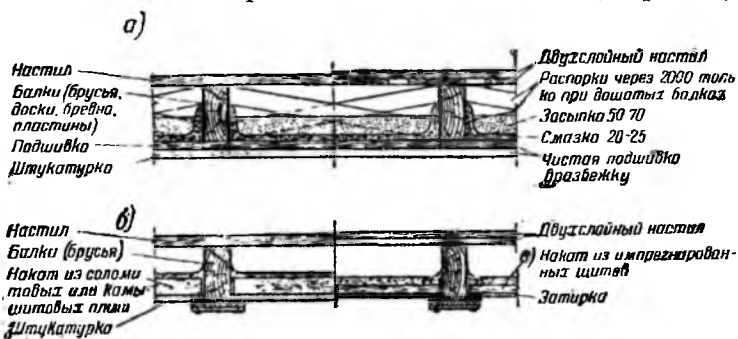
Деревянные упрощенные междуэтажные перекрытия
